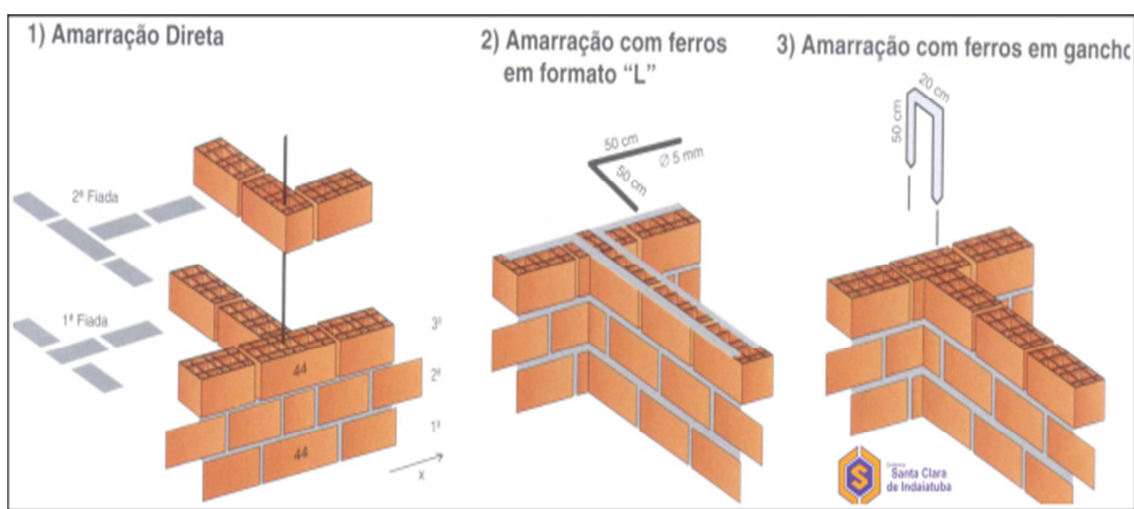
Amarração Direta e indireta com uso de barra e ganchos ou grampo.
